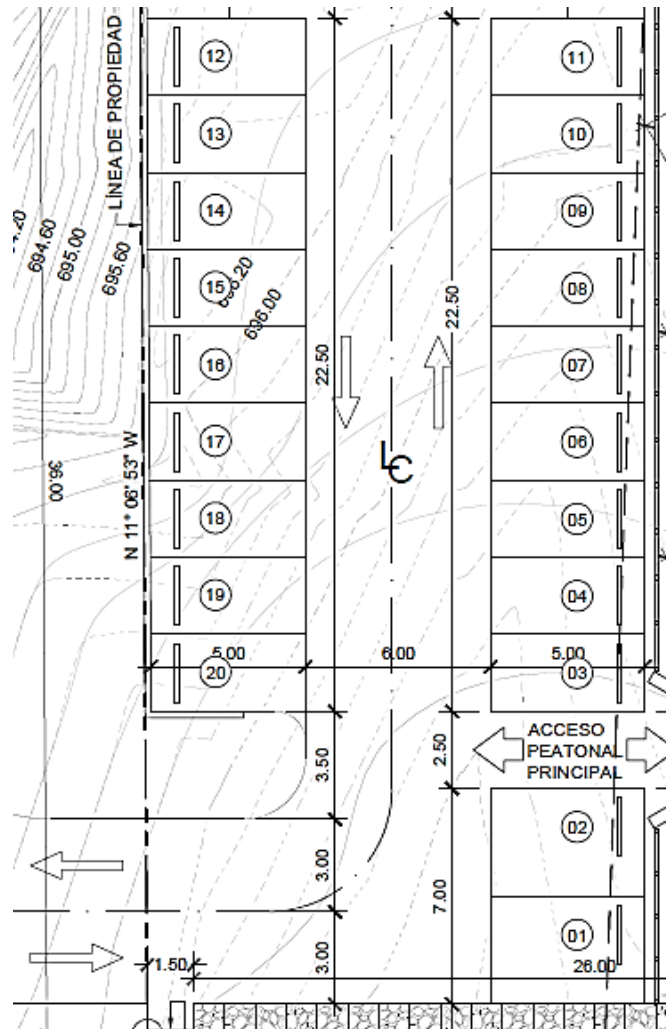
Cantidad de estacionamientos. Fuente: Planos del proyecto.
